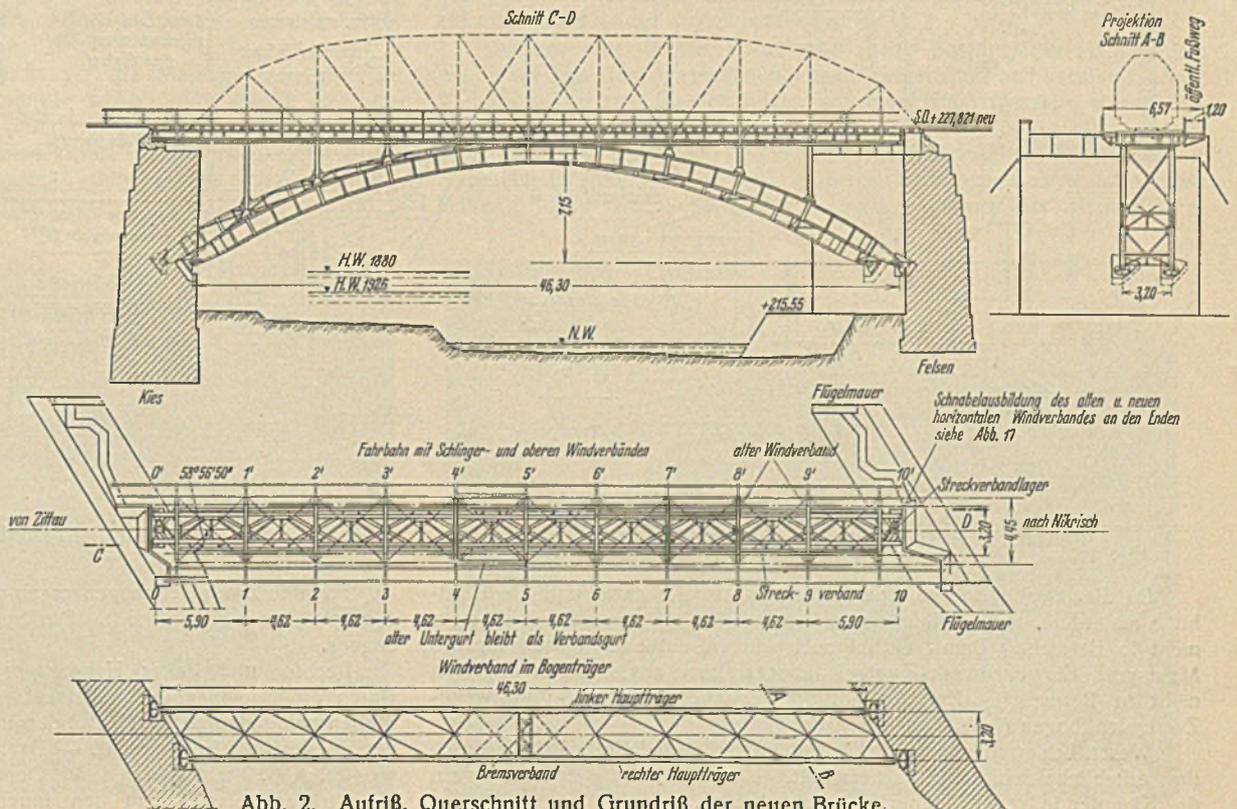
Aufriß, Querschnitt und Grundriß der neuen Brücke.
